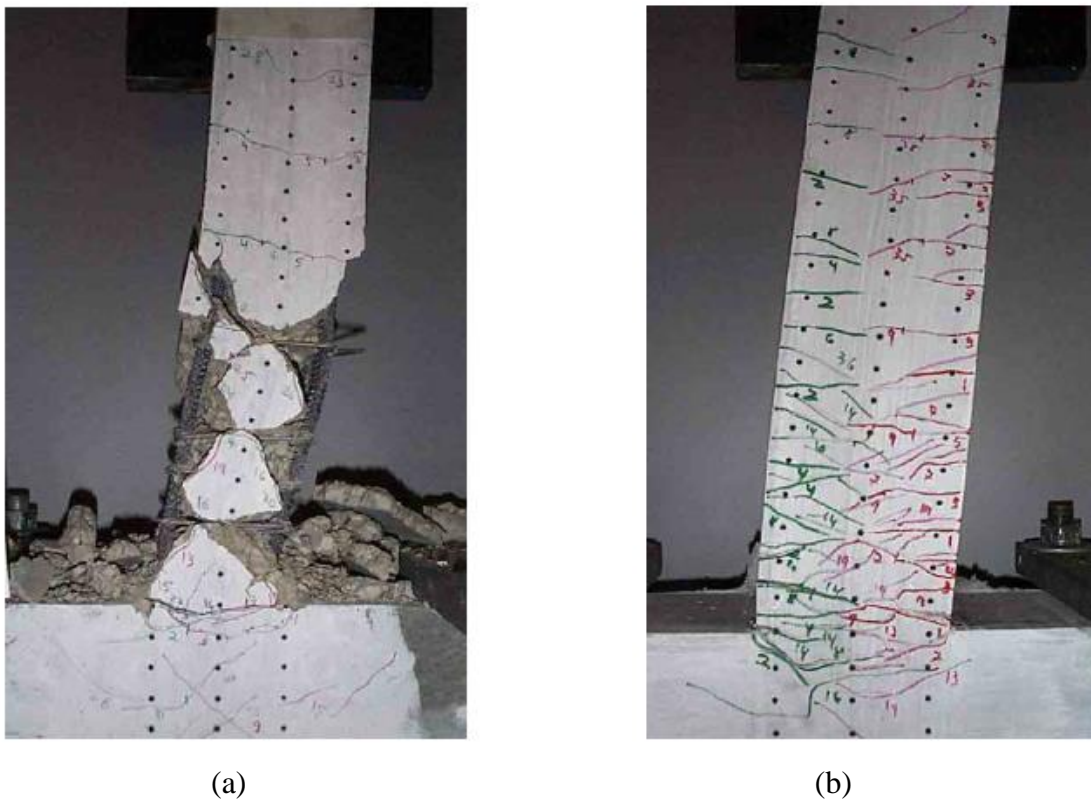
Comportement de la rupture du (a) Poteau en béton armé et (b) Poteau en CCHD sans armature transversale (Li, 2003).
